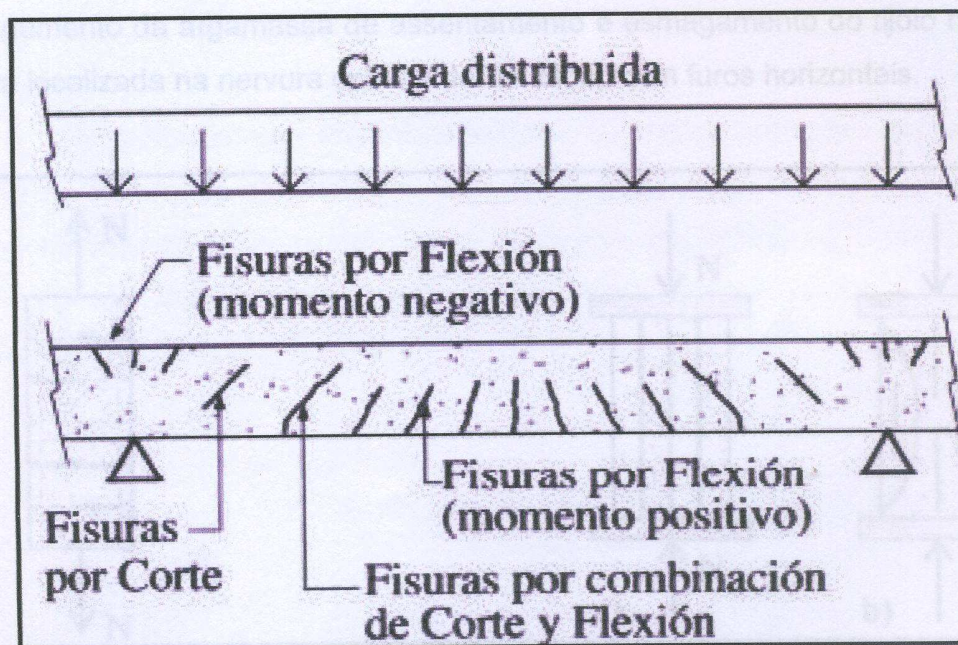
Patologia observada em viga de concreto armado com fissuração devido ao esforço cortante e flexão. (HELENE, 2003 *apud* BRANDÃO, 2007).
